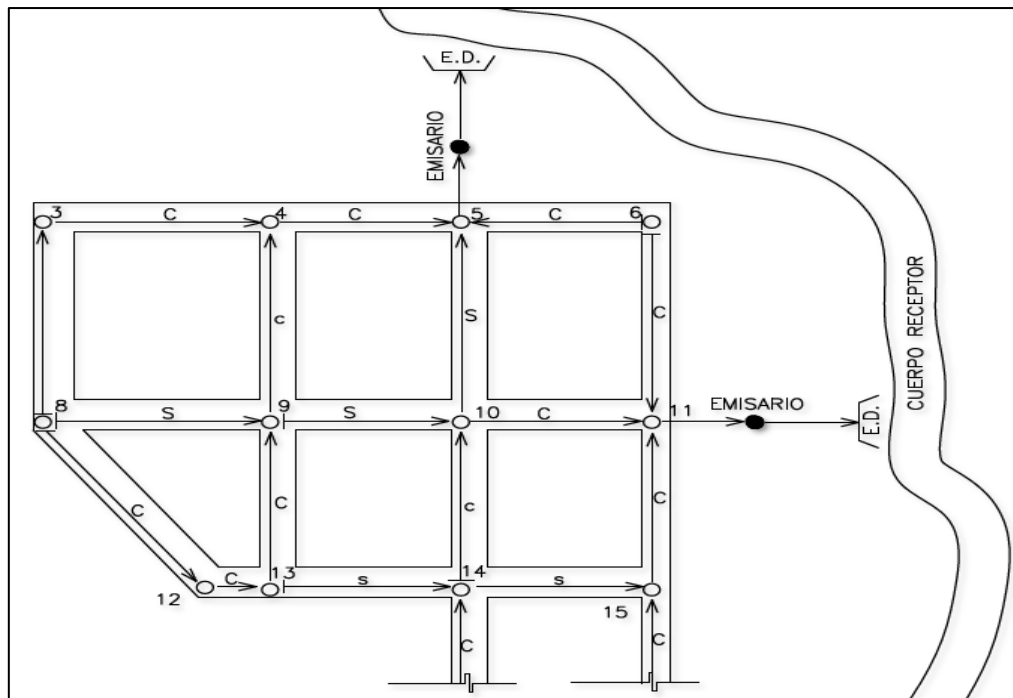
Partes constitutivas del sistema del alcantarillado pluvial.
